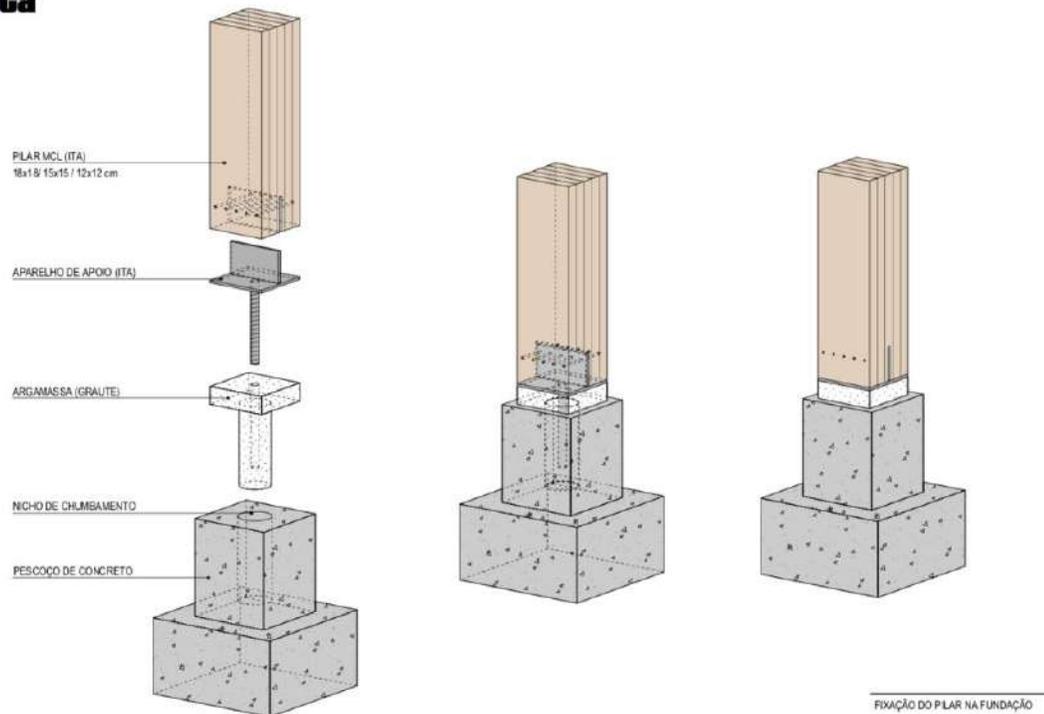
Detalhamento construtivo da fixação do pilar em MLC na fundação (fonte: Ita Construtora)
